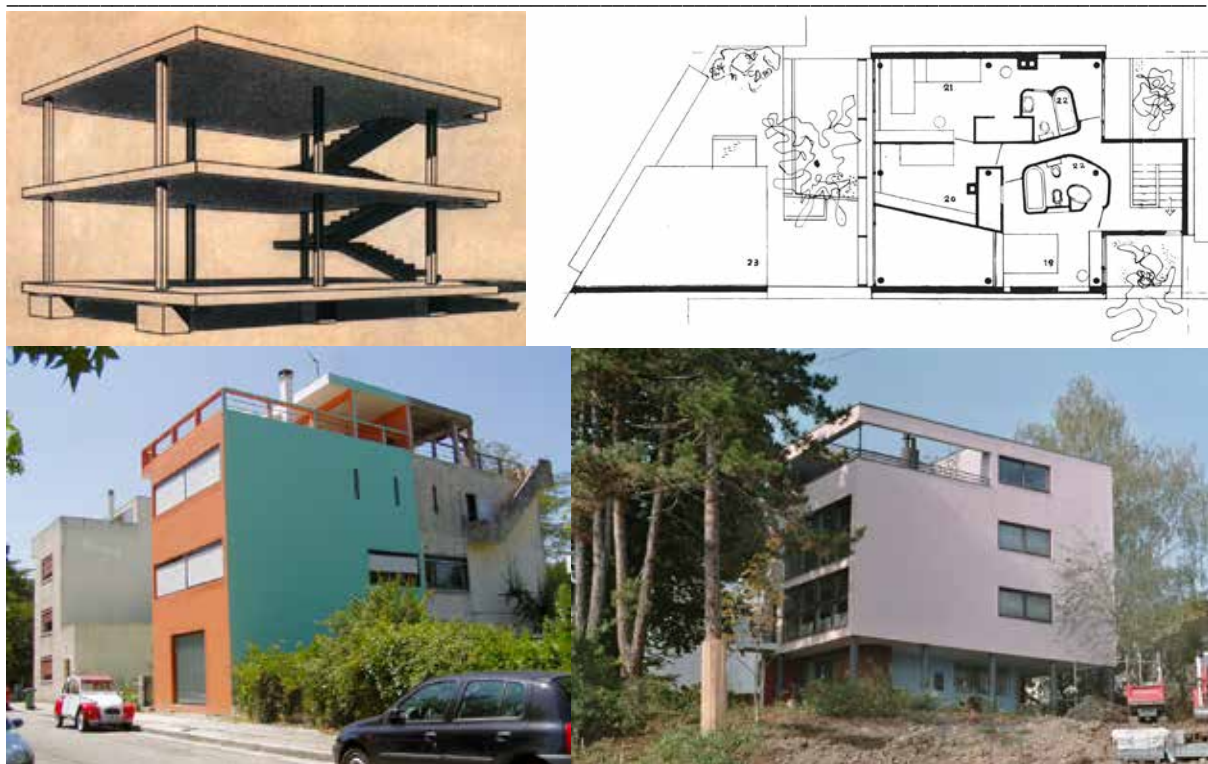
perspectiva representando a estrutura Dom-ino (1914-1947), de Le Corbusier. A estrutura independente dada por poucos pilares afastados da borda da laje possibilita a independência das fachadas e das paredes internas. Essa ação seria garantida pelo fundo liso das lajes dos pavimentos;
